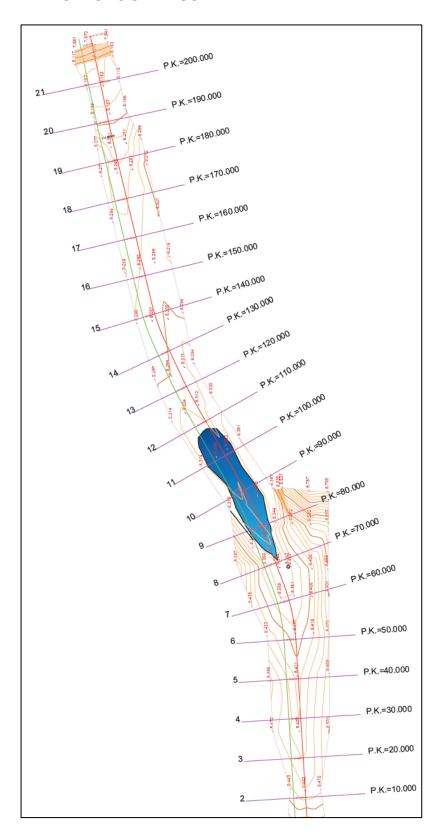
Plano de planta del Levantamiento topográfico del entorno del canal La Lonja
